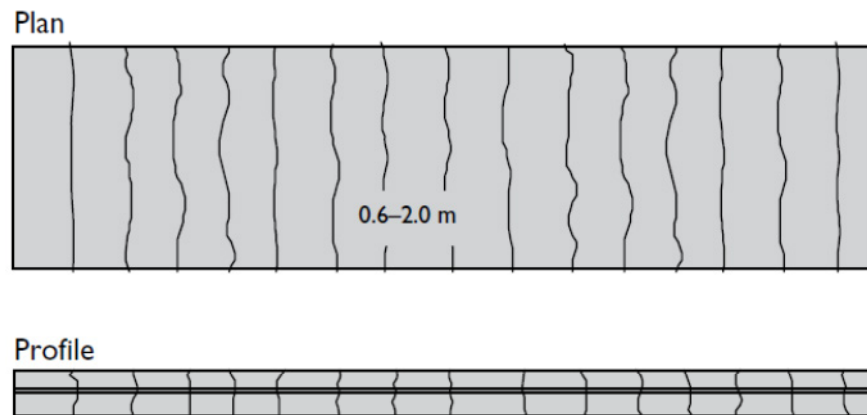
Esquema del pavimento de concreto continuamente reforzado (Continuously reinforced concrete pavement (CRCP)). (Fuente: ACPA)
